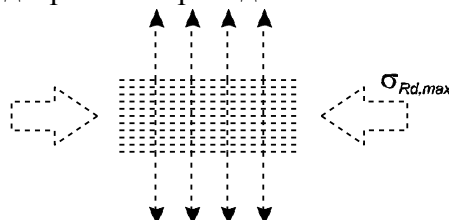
Расчетное значение прочности бетонных распорок с поперечным растяжением
